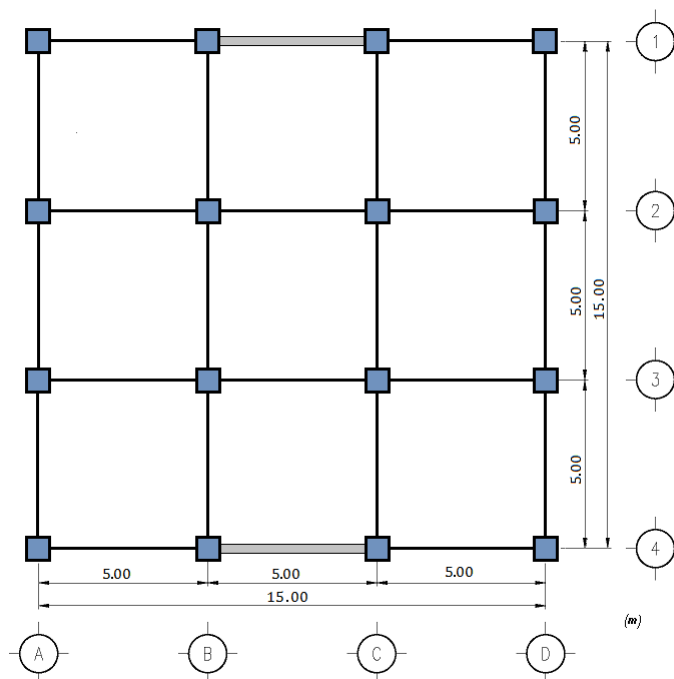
Planta tipo correspondiente a los edificios de 10 y 15 niveles
